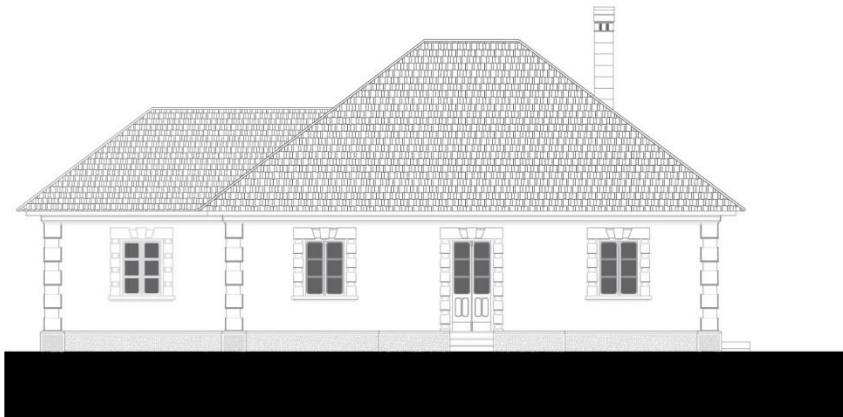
Fachada oeste, 1940 [?], (hipótese do autor).
